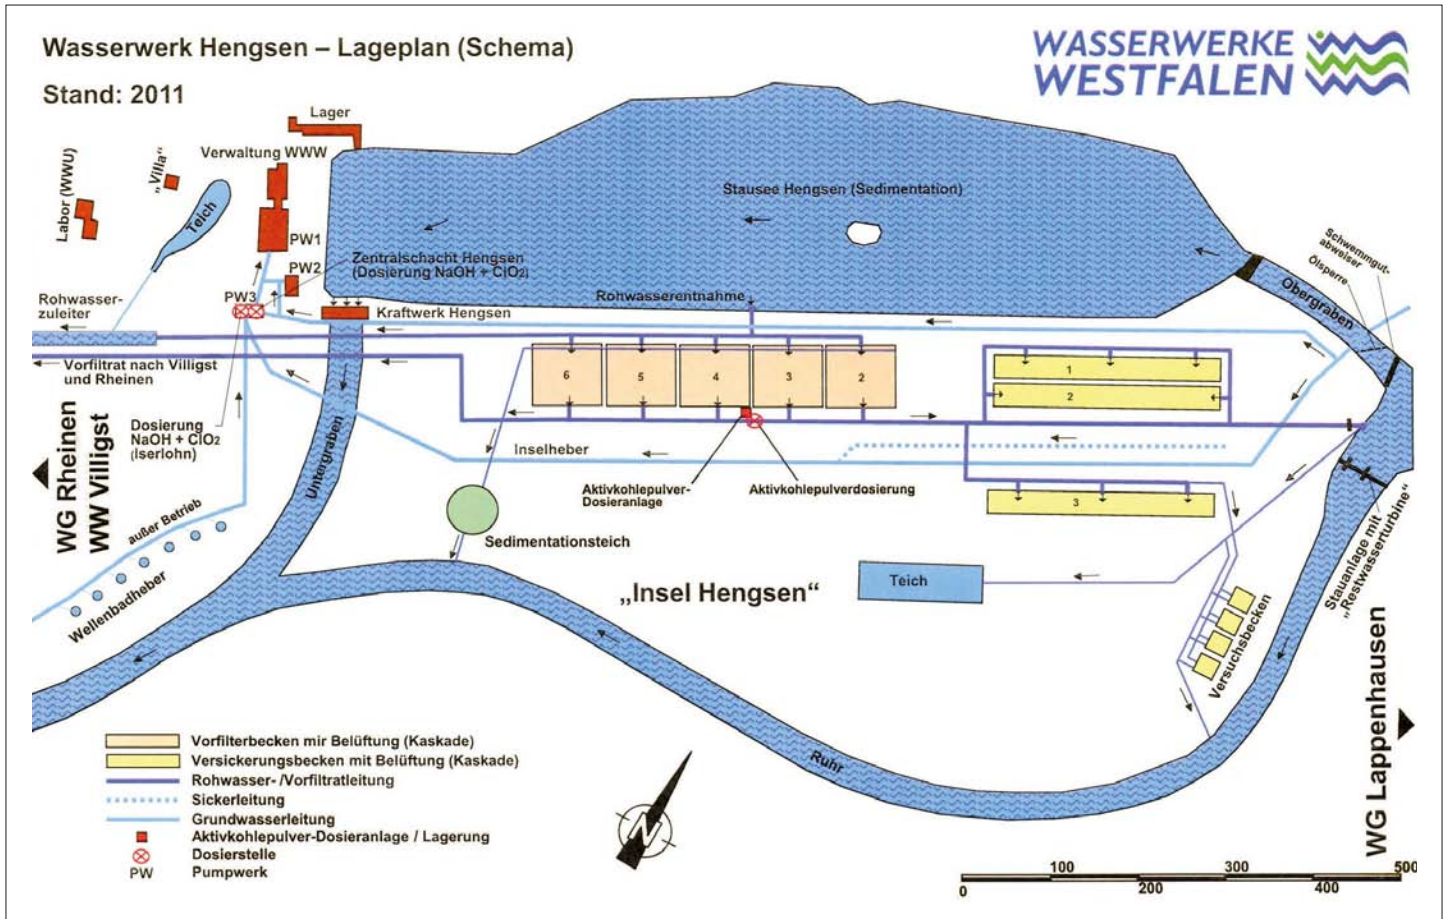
Lageplan (Schema) des Wasserwerks Hengsen
